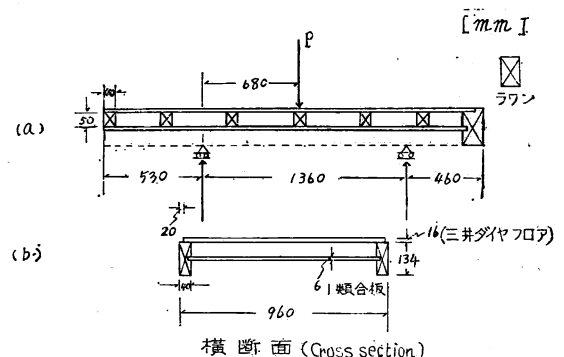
床パネルの断面構成、寸法および曲げ試験方法
